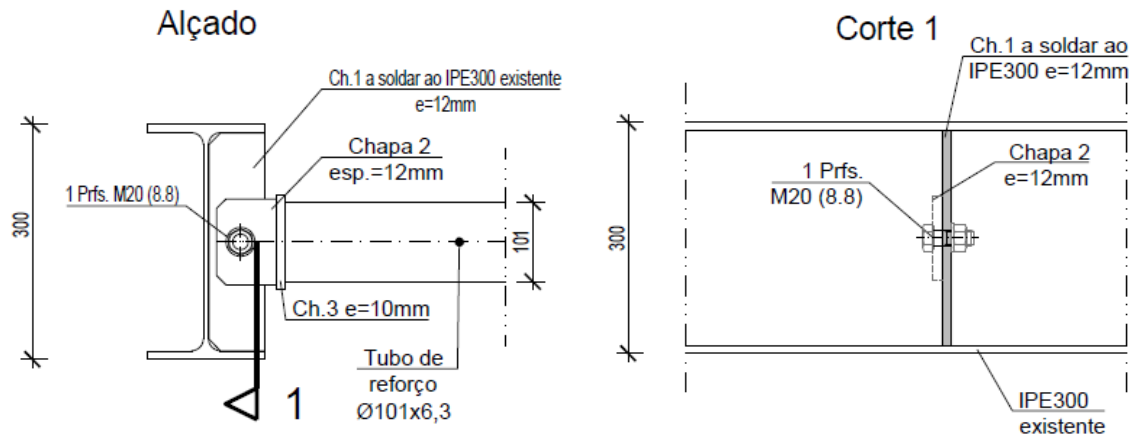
Alçado e corte do pormenor de reforço das vigas.
